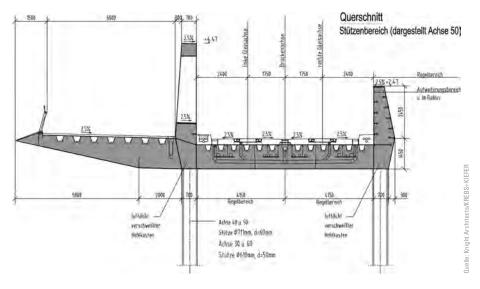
Kienlesbergbrücke: Brückenquerschnitt im Stützbereich Kienlesberg bridge: cross section of main span above piers
